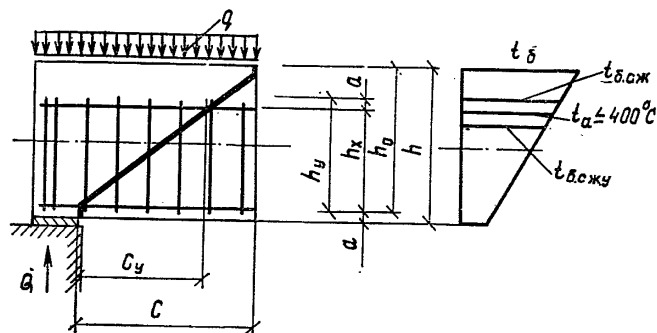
Схема наклонного сечения железобетонного элемента с укороченными по высоте сечения хомутами
